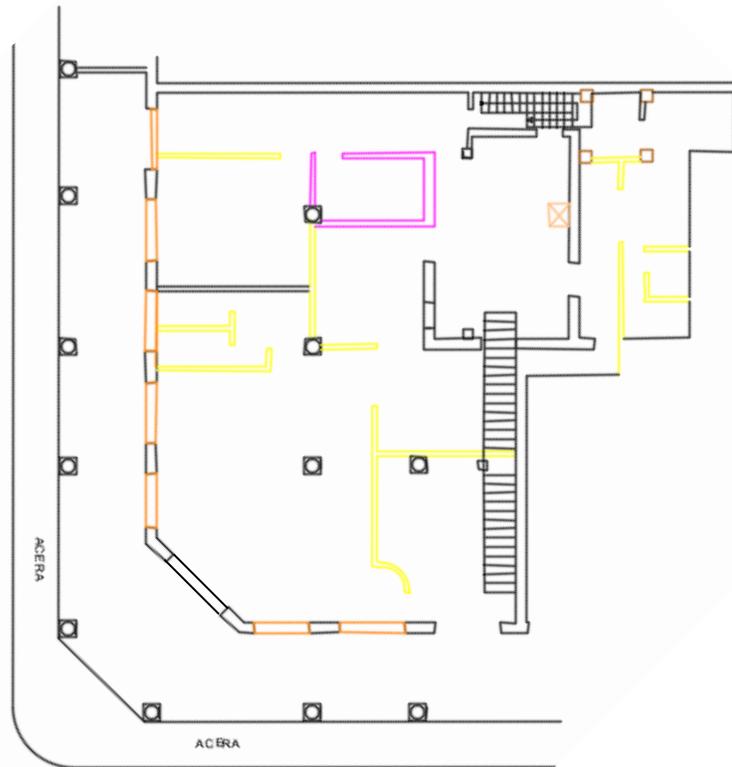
Planta actual donde se representan en color amarillo los muros que no constituyen los de la construcción inicial. Fuente: Elaboración propia.
